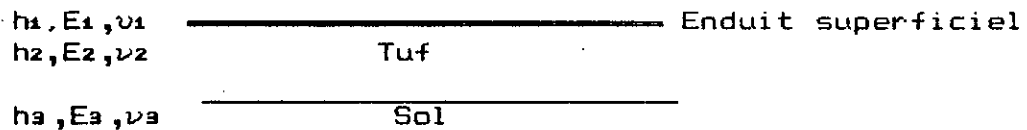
chaussée en tuf revêtue de 2cm d'un enduit superficiel.
